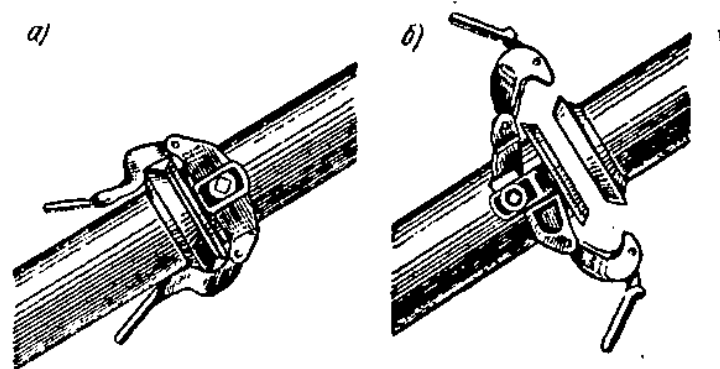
Быстродействующие рычажные замки для соединения труб бетоновода:
